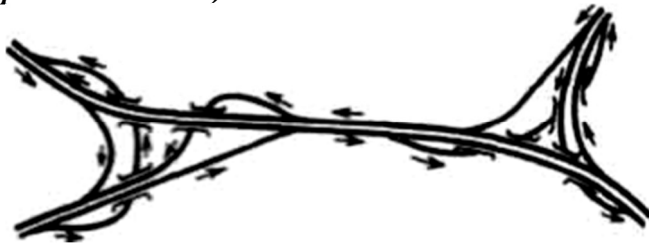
Лінійний тип перехрещення з 6-ма шляхопроводами
